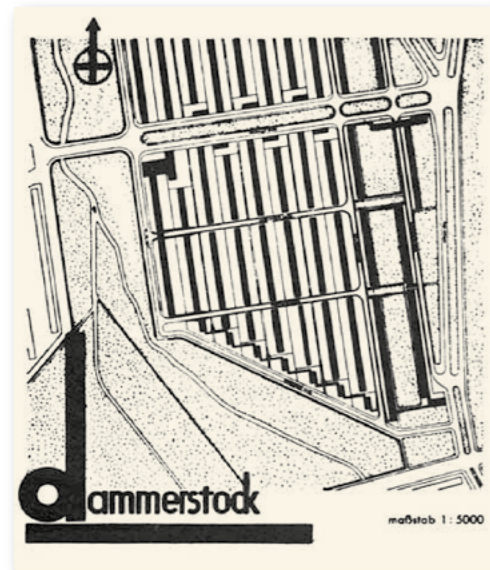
Dammerstock planta general y viviendas plurifamiliares (Gropius, 1928)
